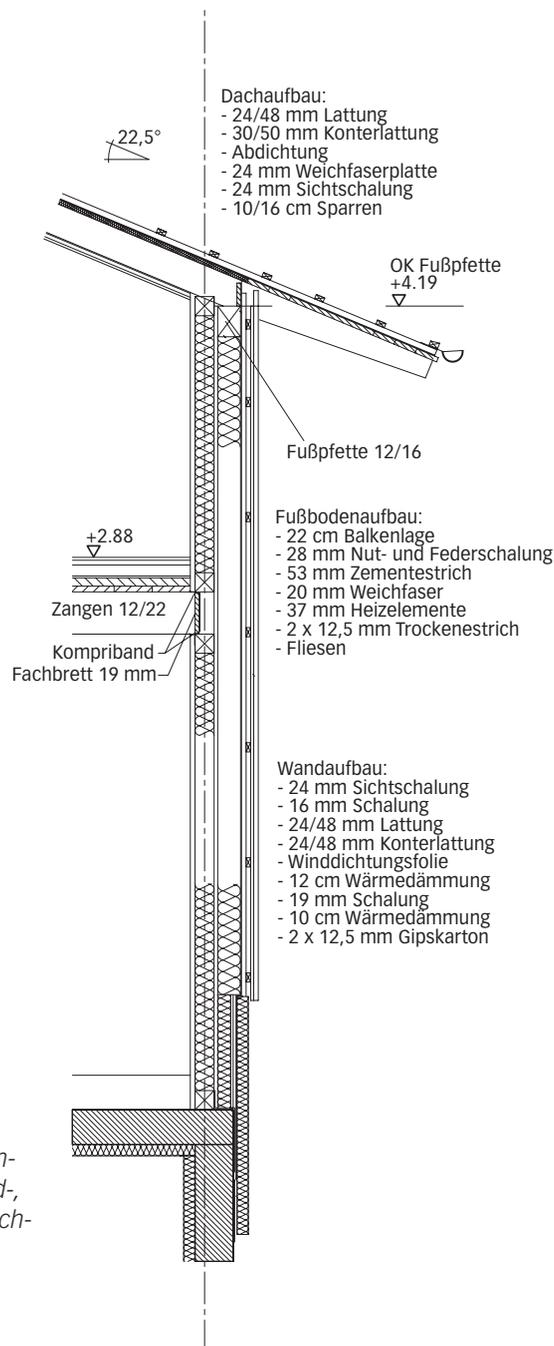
Fassadenschnitt mit Wand-, Decken- und Dachaufbau
